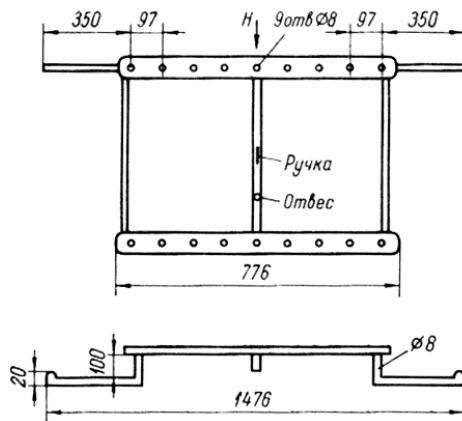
Шаблон разметки отверстий для установки кронштейнов под радиаторы
